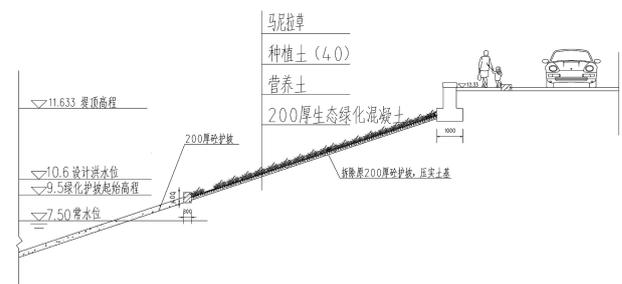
河道护坡前后对比及生态绿化混凝土护坡结构示意图
